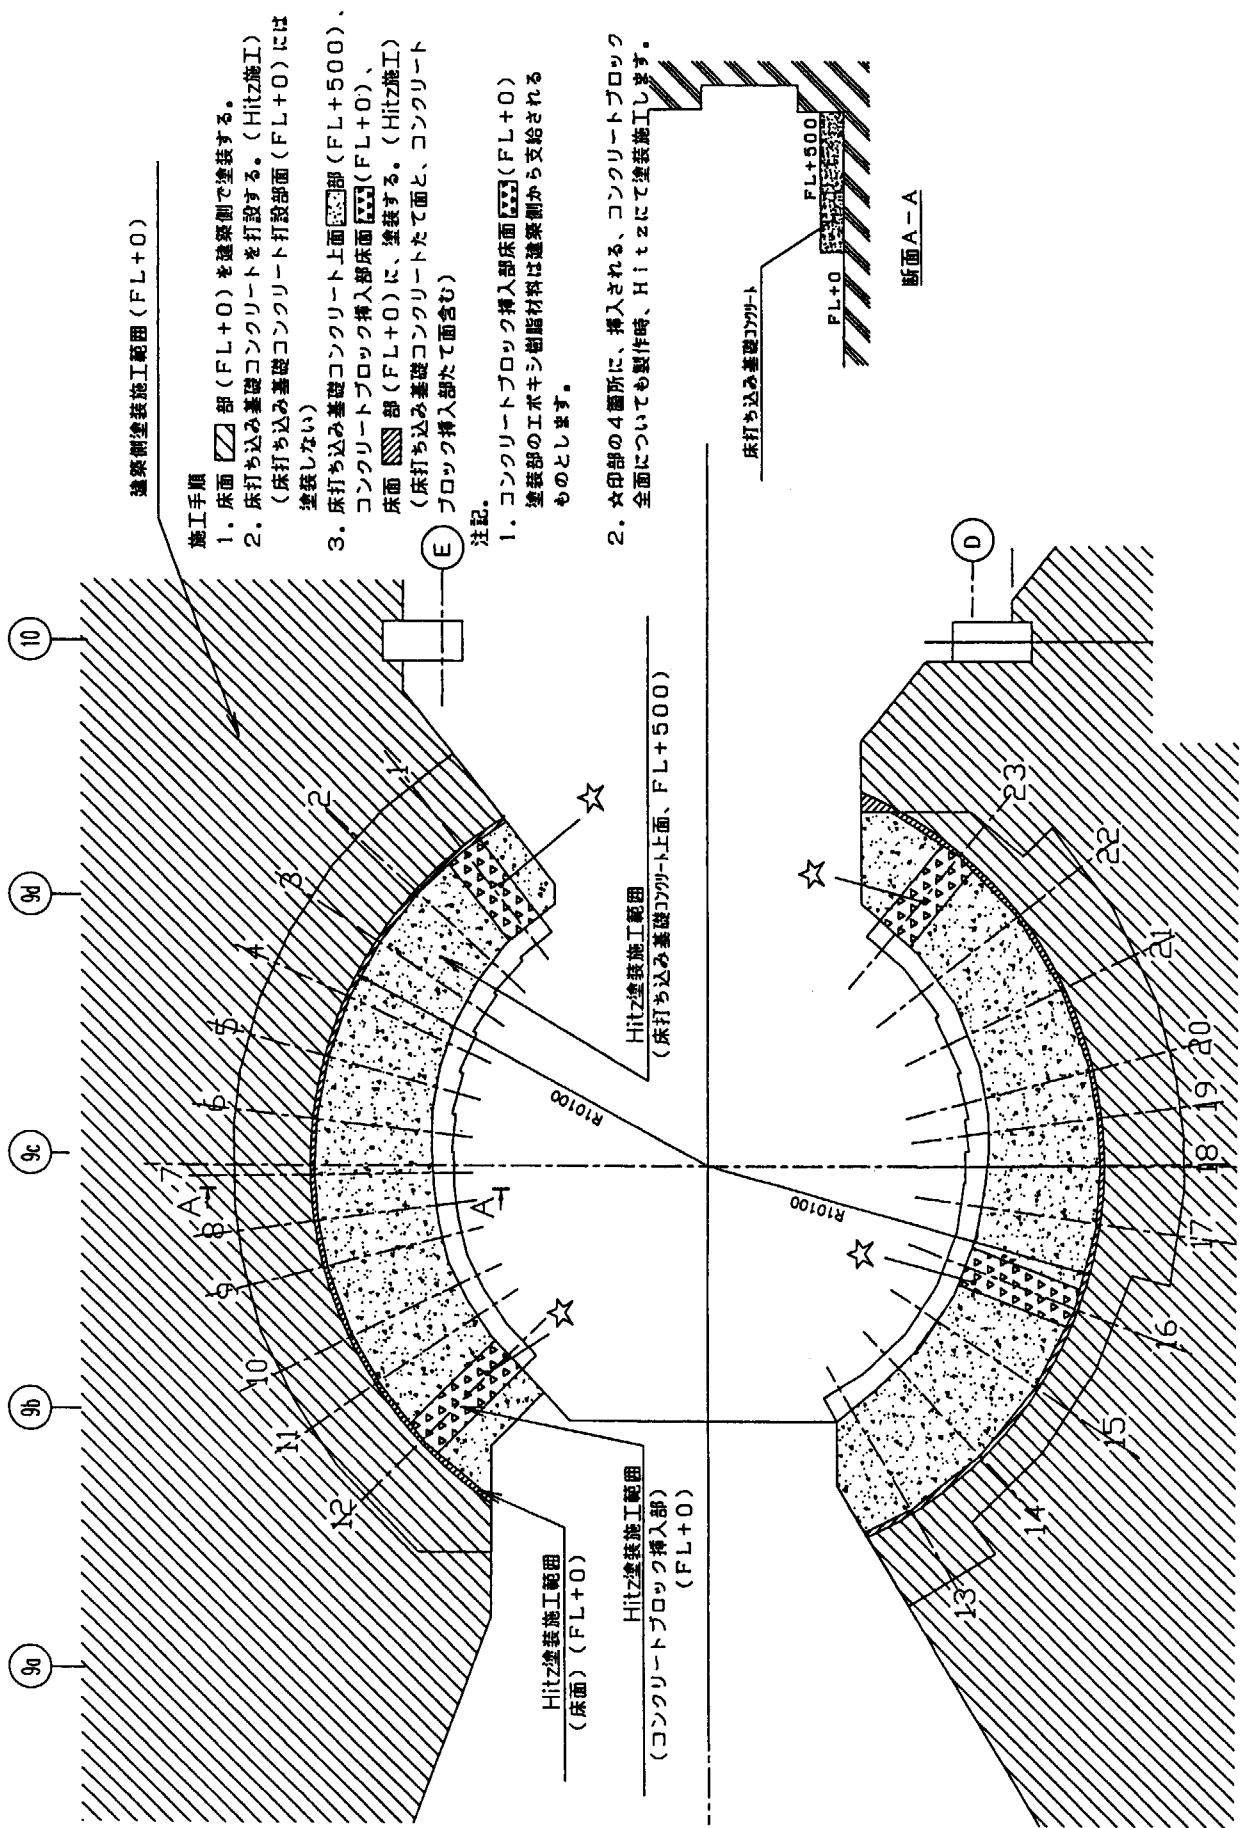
前置き遮蔽体 床面塗装施工範囲計画図
